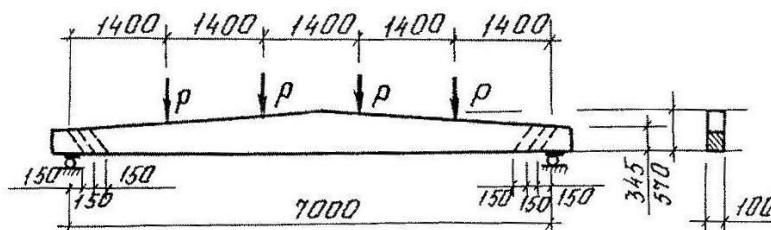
Схема усиления и нагружения при испытании дощатоклееных балок пролетом 7 м наклонными клееными стержнями
